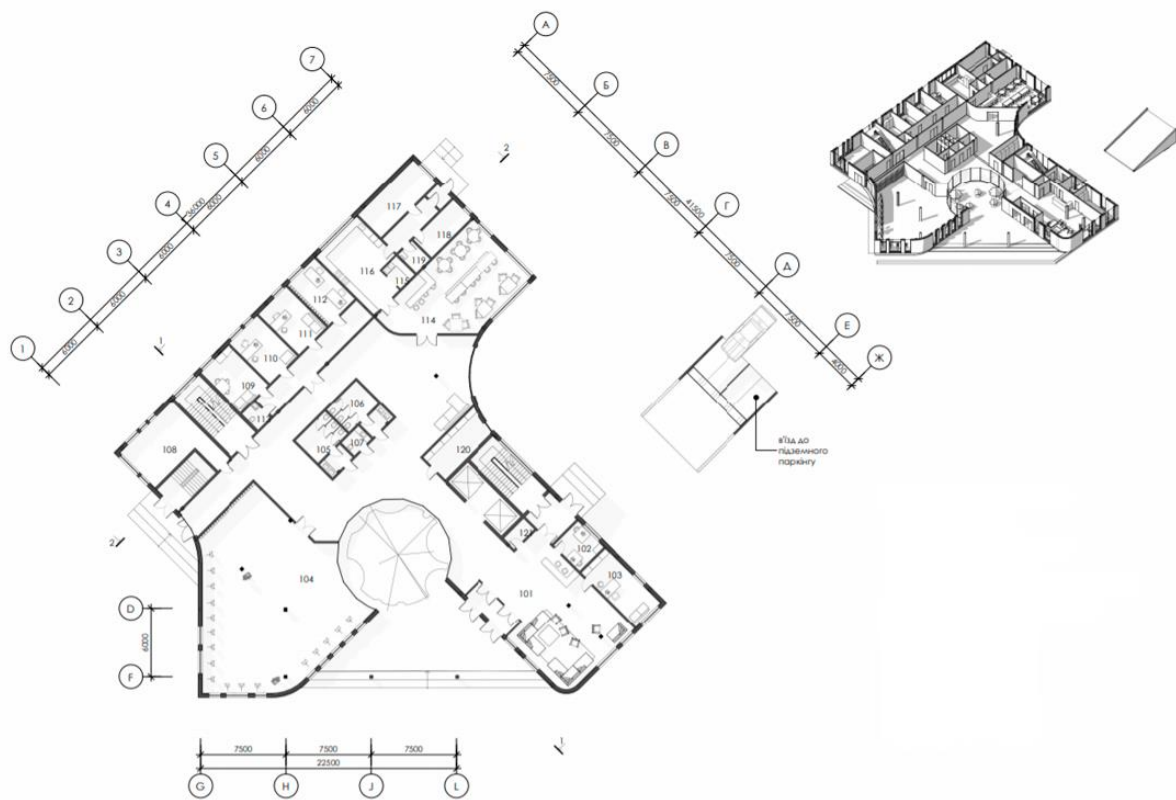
(схема плану поверху на відмітці 0.000)
